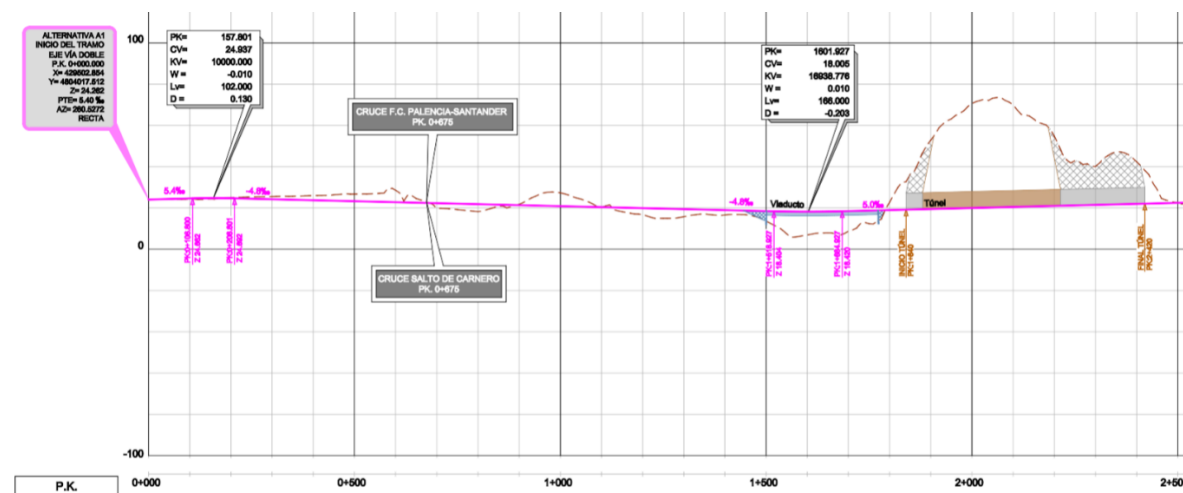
Perfil longitudinal Alternativa A1 rasante baja. Salto de carnero
